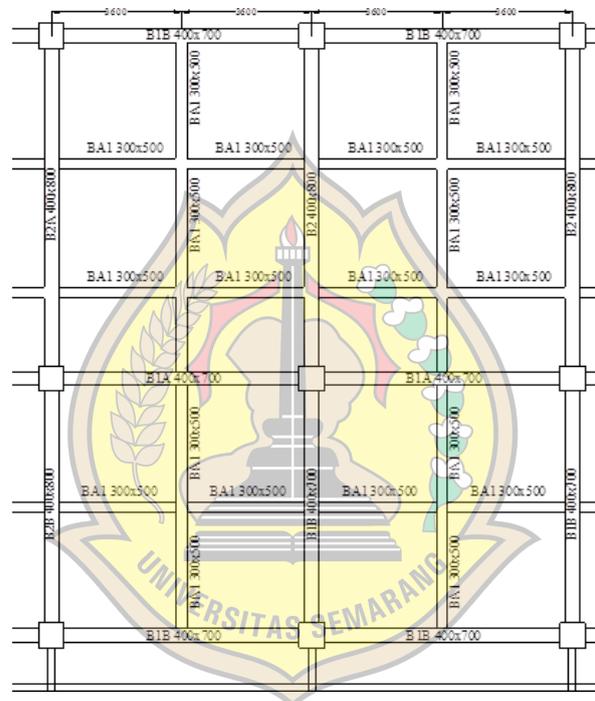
52 Pemodelan Gedung menggunakan Aplikasi SAP2000
